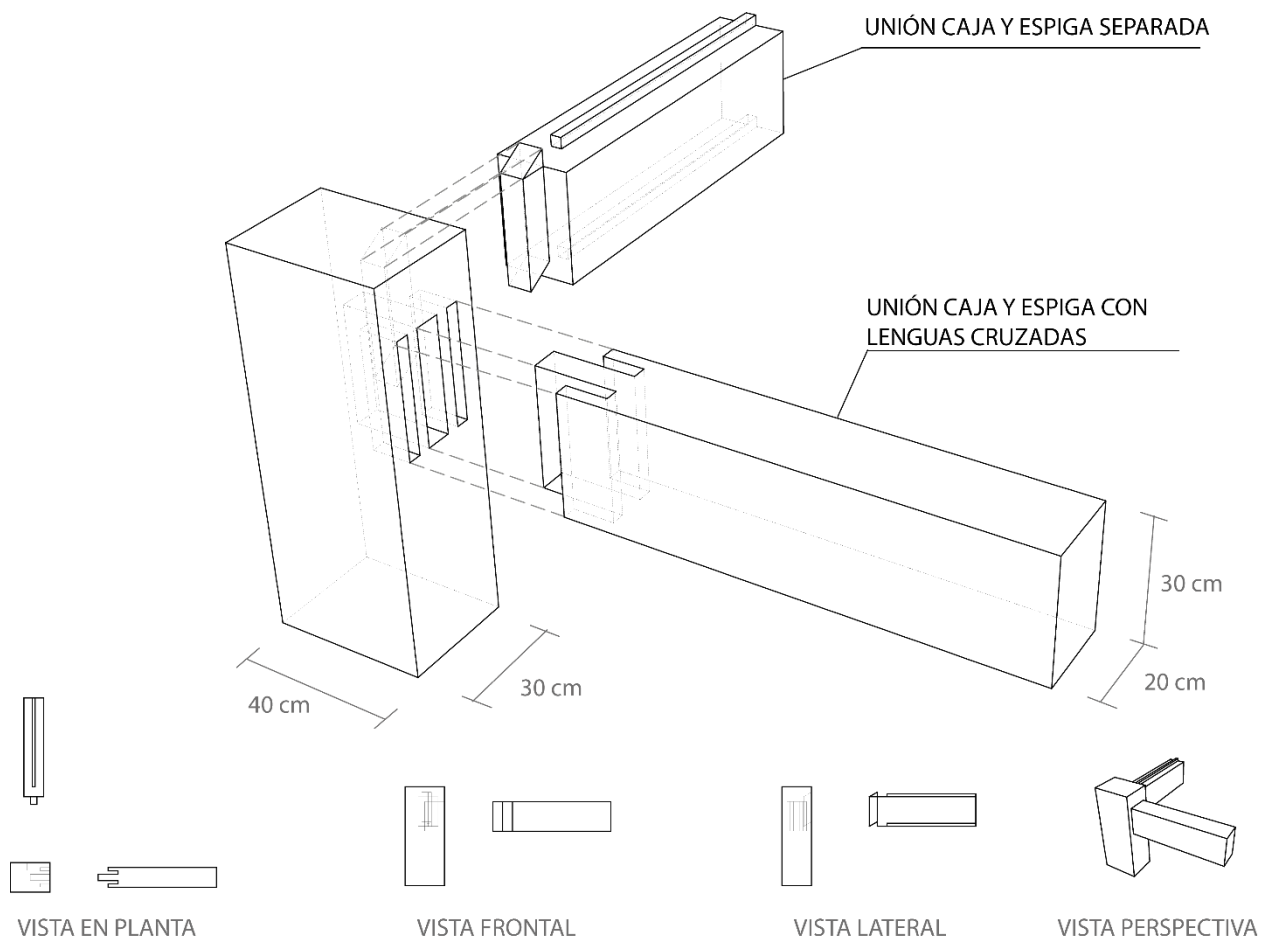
Diseño preliminar unión pilar-viga esquina. Elaboración propia.
